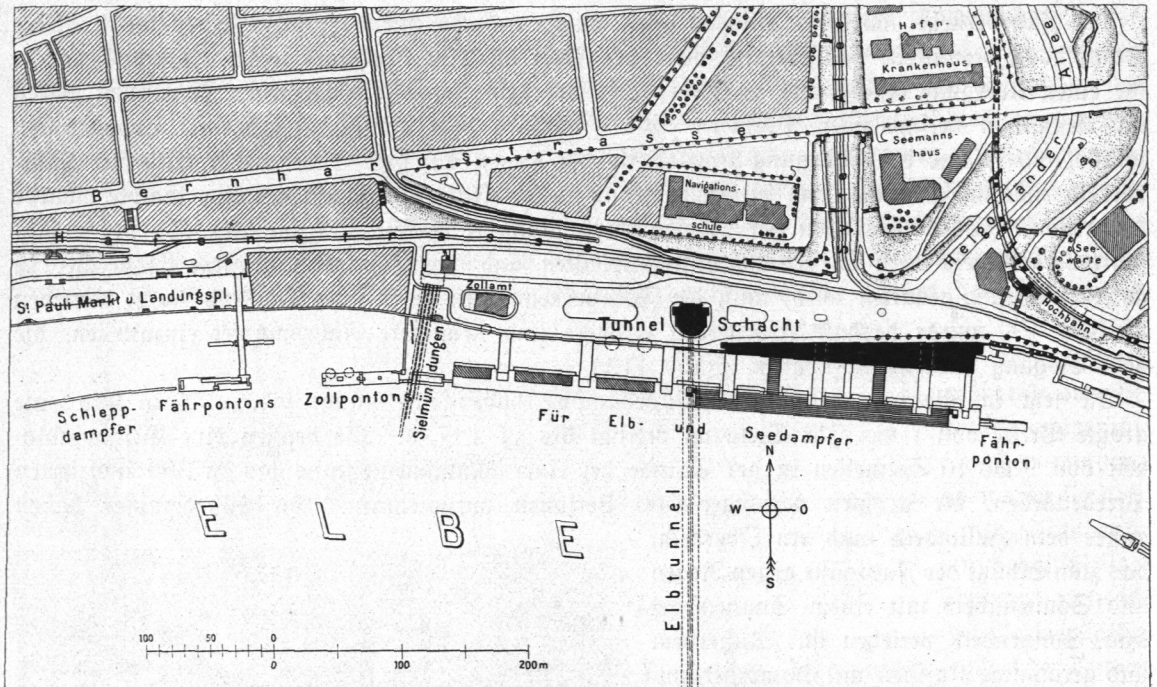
St.-Pauli-Landungsbrücken, Lageplan.
